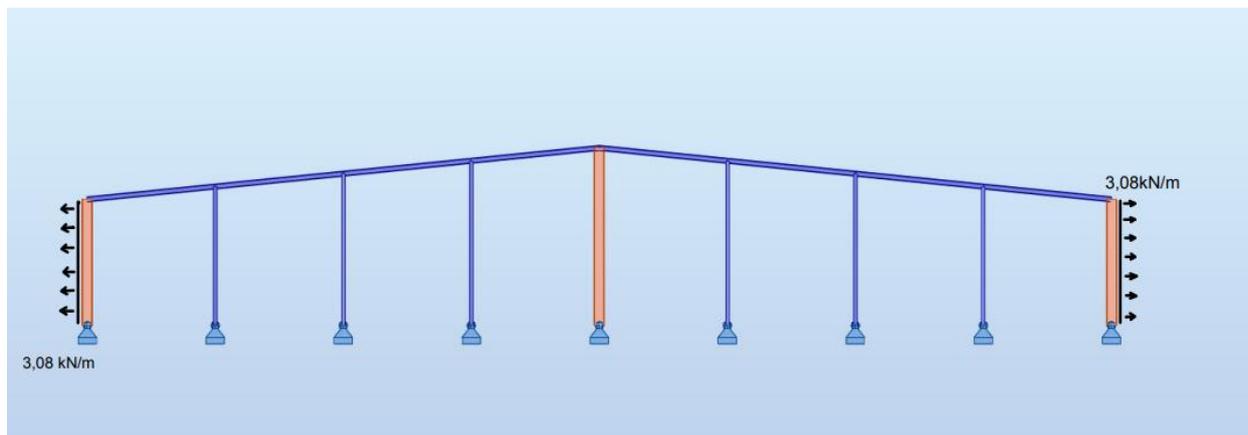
REPRESENTACIÓN CARGAS DE VIENTO EN ZONA A EN PÓRTICO DE FACHADA (PLANO PARALELO AL PÓRTICO) CON DIRECCIÓN LONGITUDINAL A LA FACHADA
